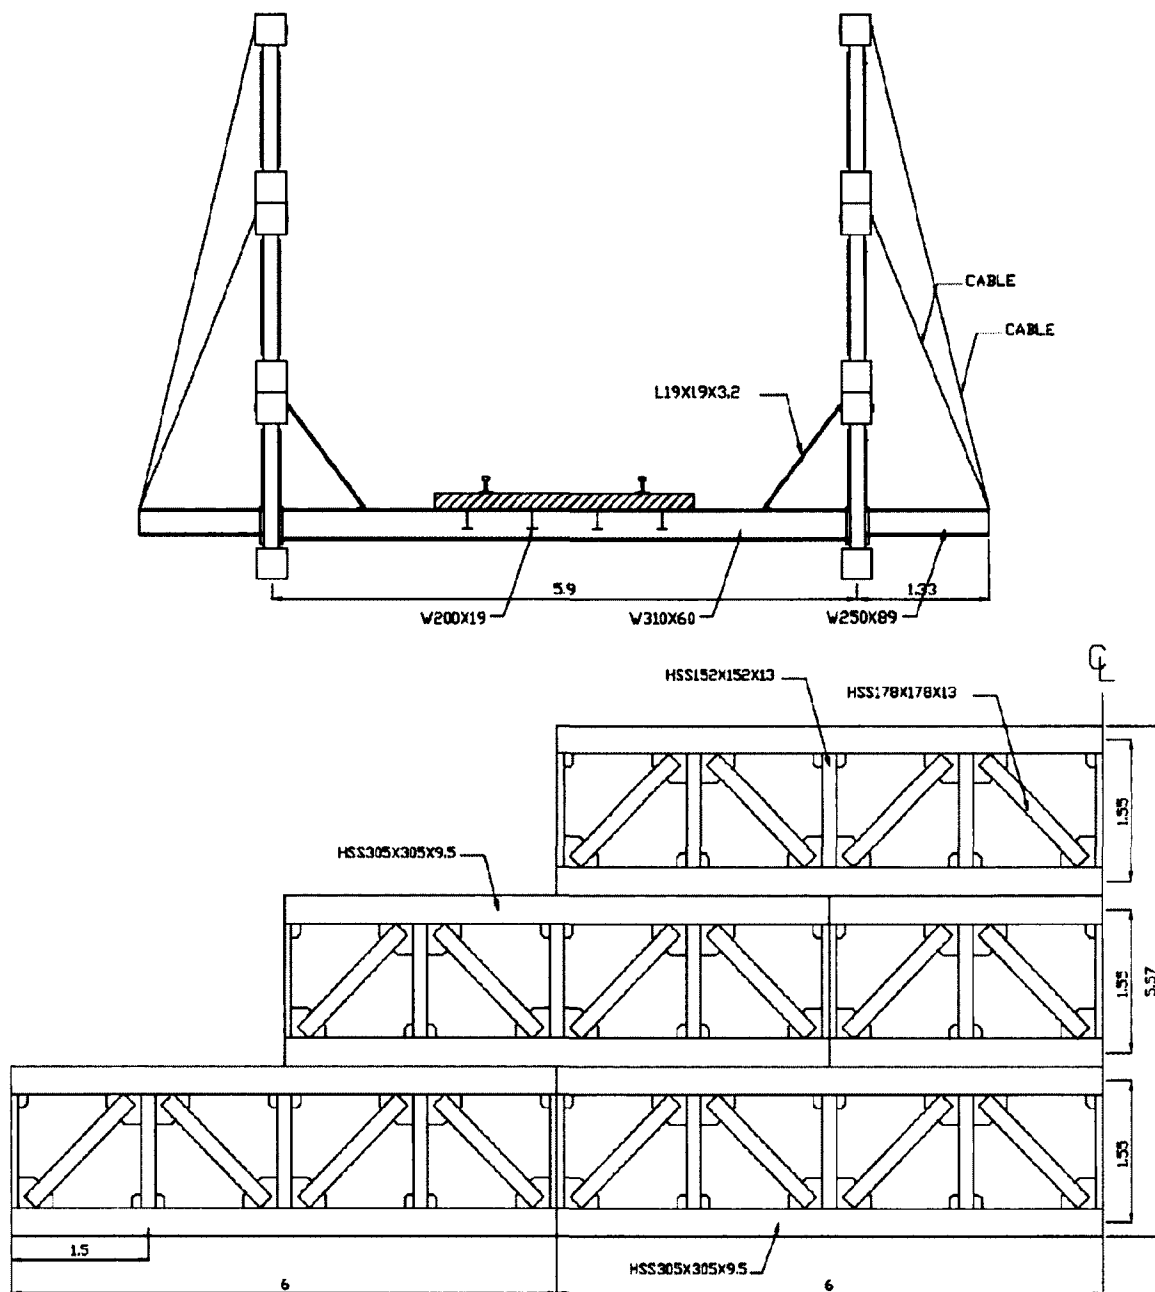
Pont à treillis latéraux - Section et élévation - Section C-C
